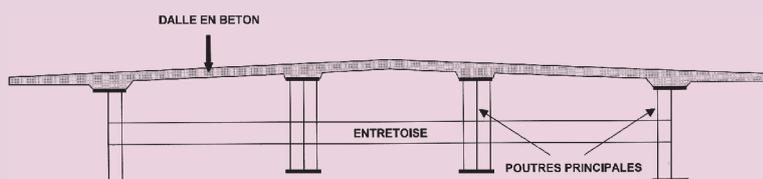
Quadripoutre mixte (cas d'une chaussée à dévers en toit)
